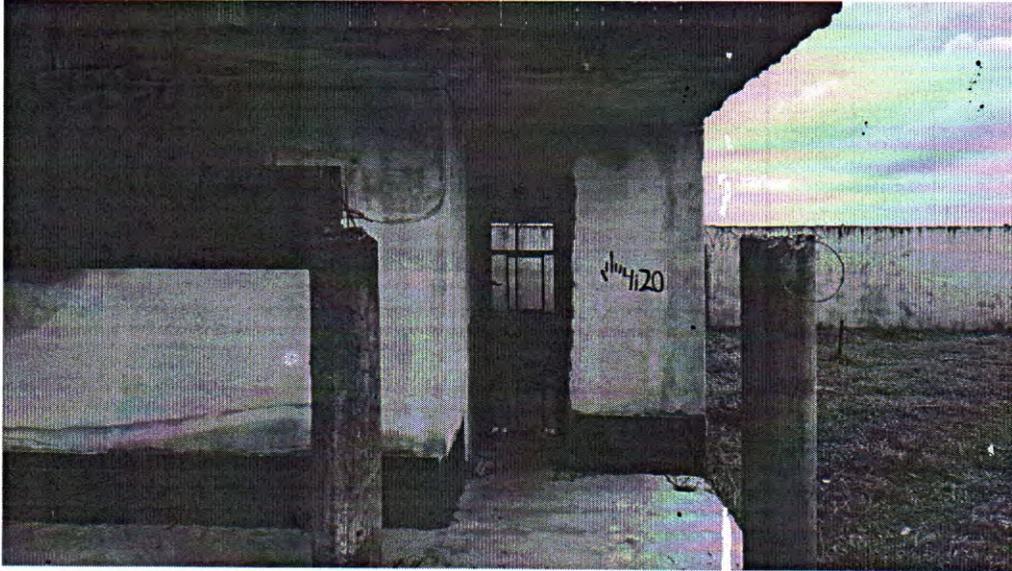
Pátio - área externa - Pilares com armadura exposta. Fonte: Acervo técnico
